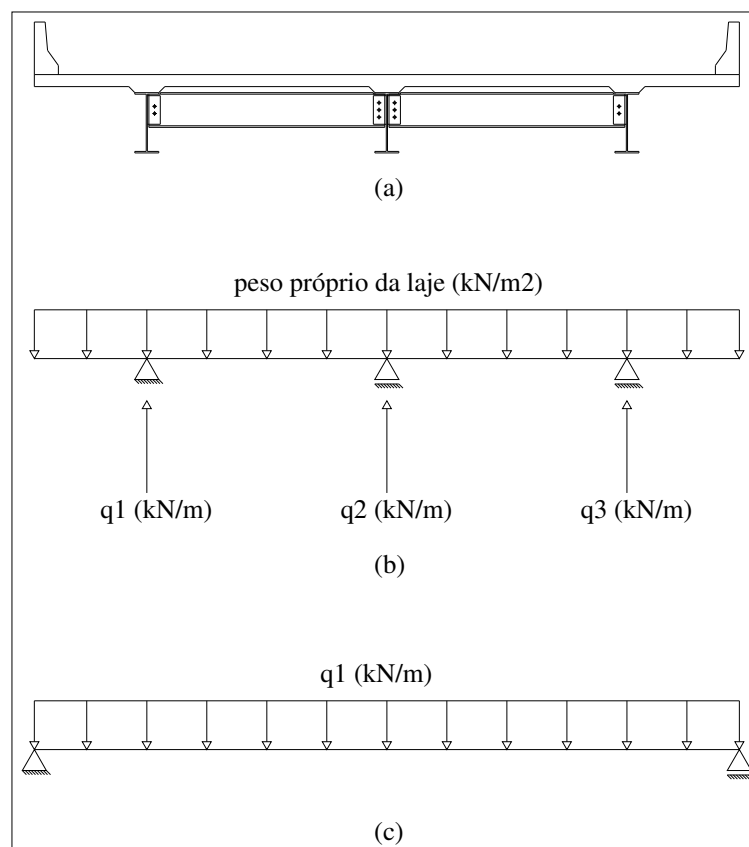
Distribuição de cargas devidas ao peso próprio da laje de concreto e do peso próprio das vigas principais.
